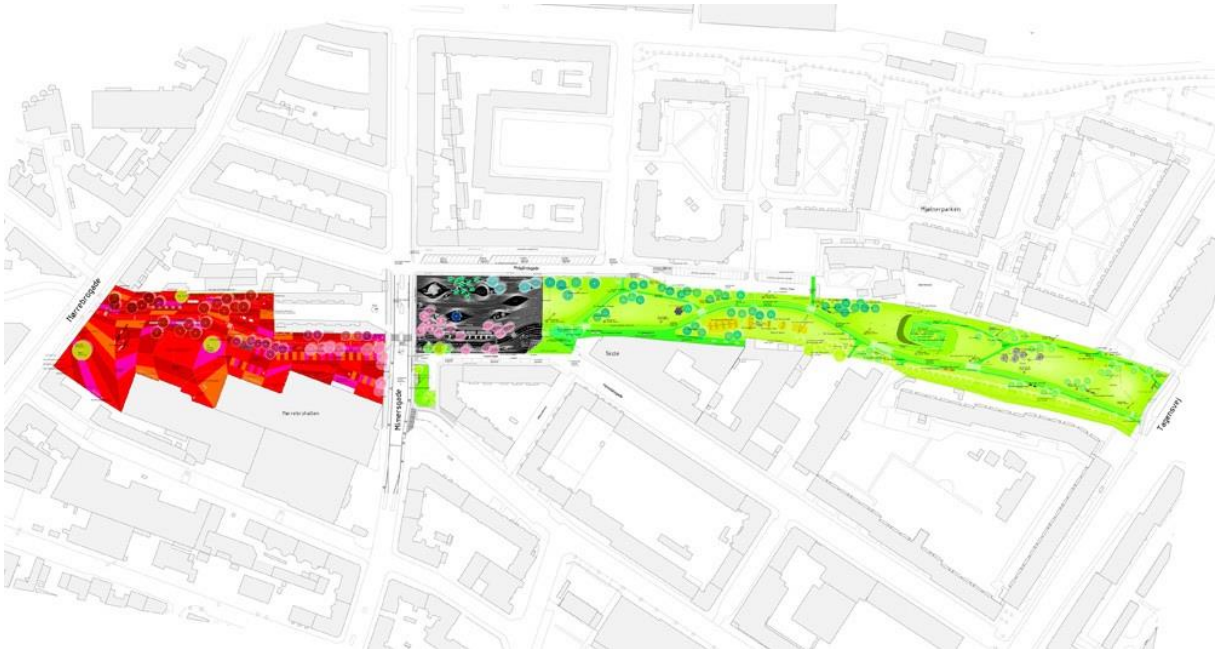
plan de masse, le parc du vivre ensemble à copenhagen.
